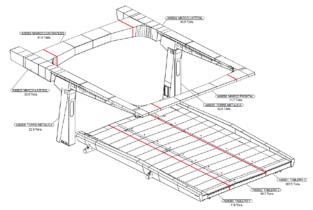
Piezas de estructura metálica para su fabricación en taller (Fuente: Horta Coslada)
